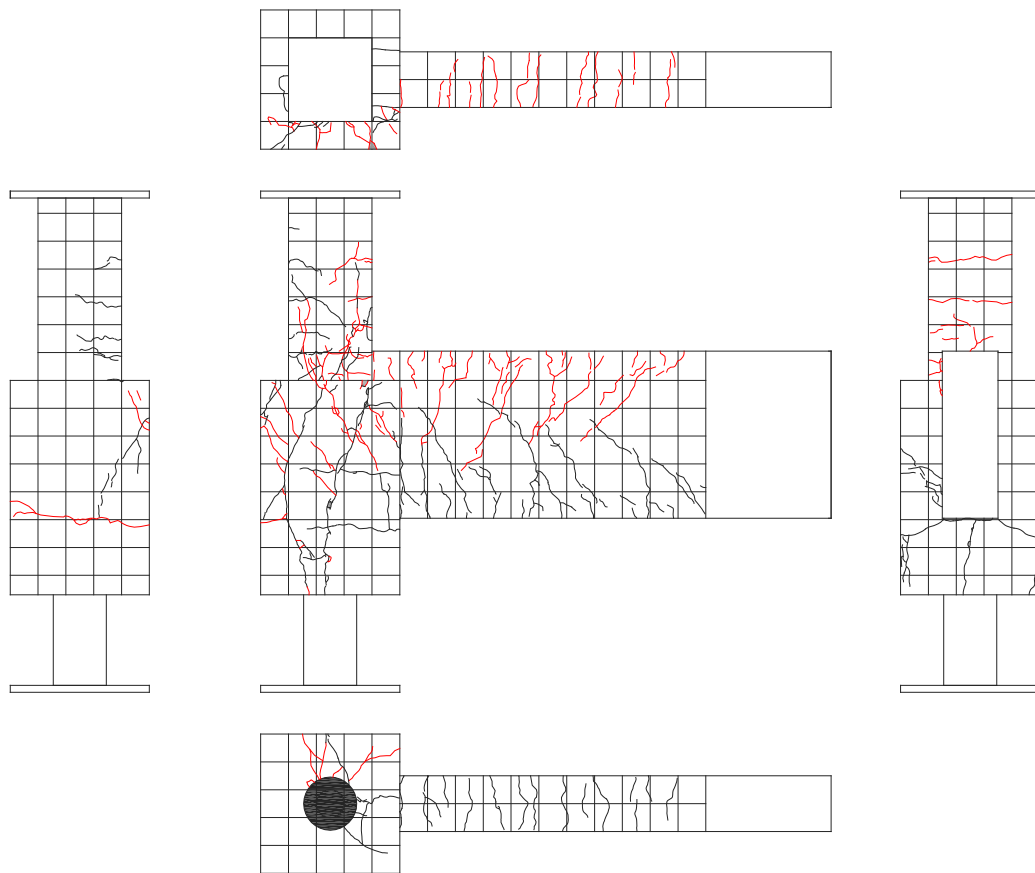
試験体 A-4 ひび割れ状況 (60cycle)
